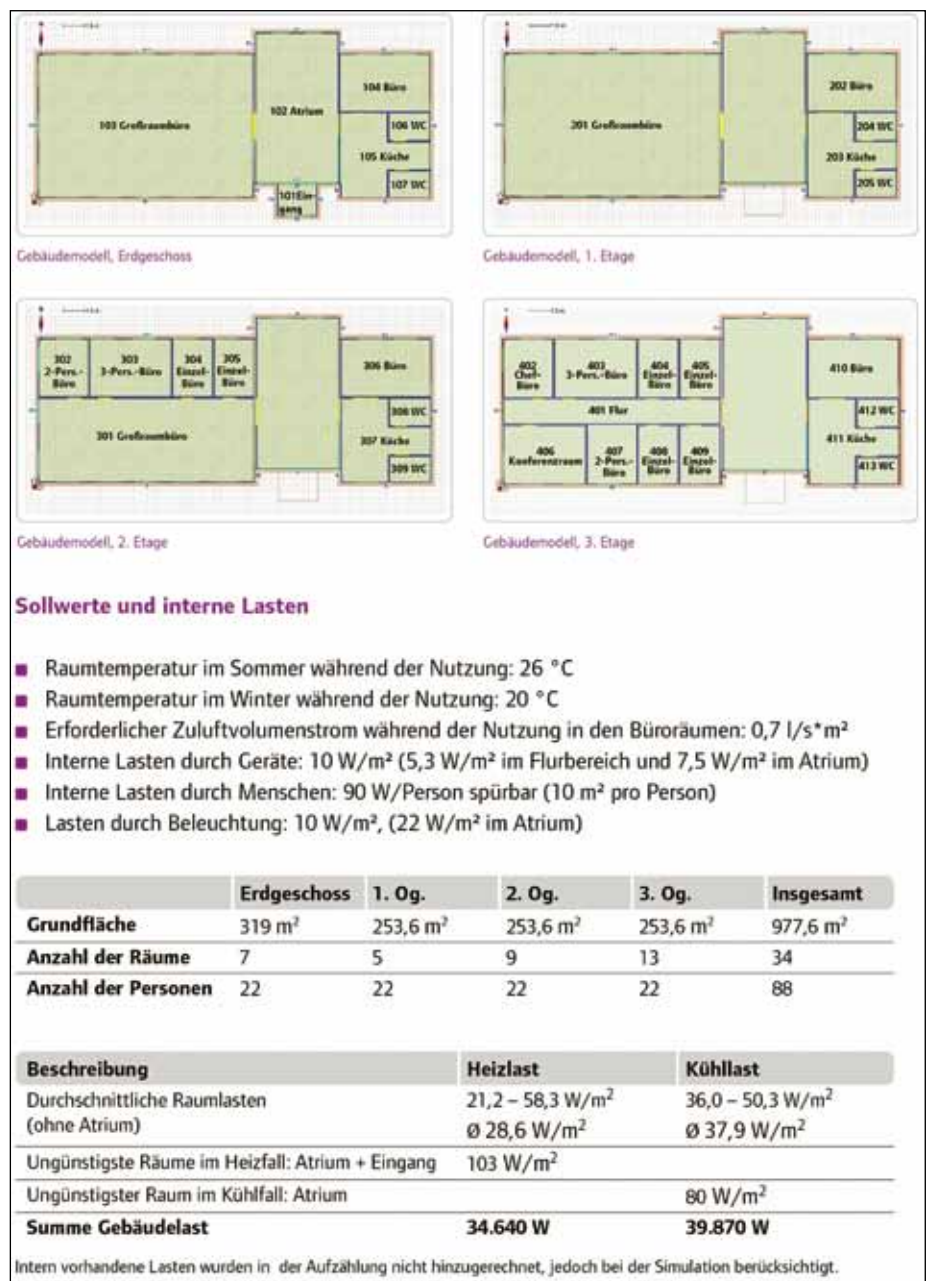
Grundriss und Planungsdaten des Gebäudemodells.
